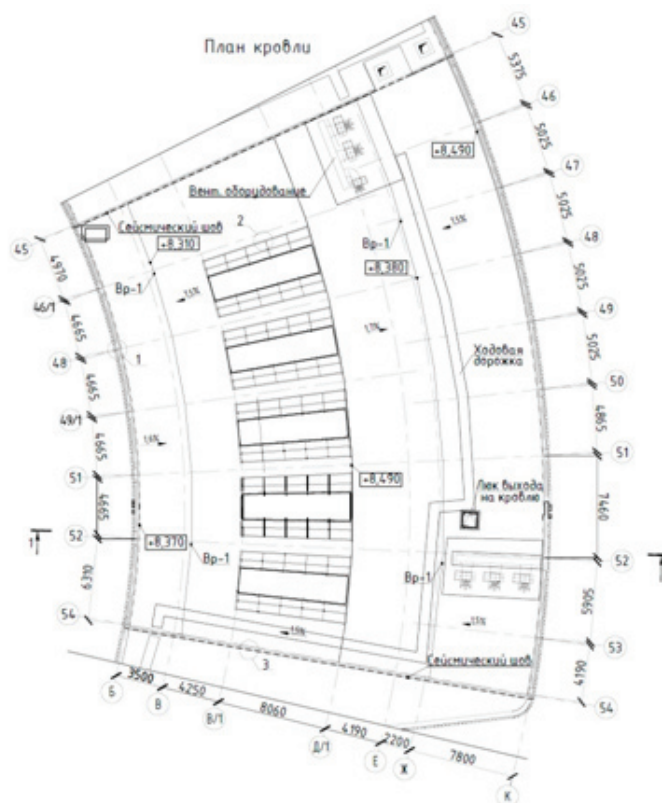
План кровли. Автор – Н.Р. Проничкин
